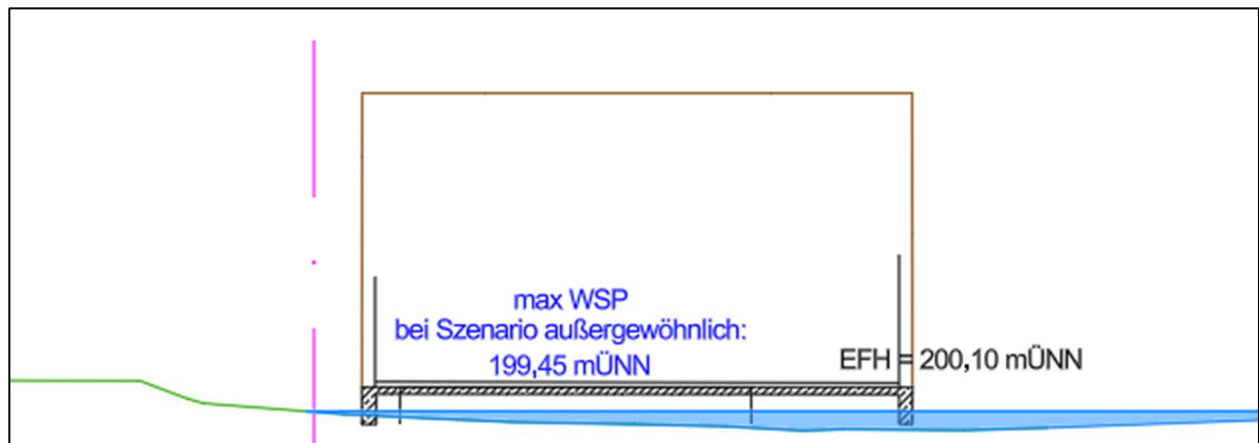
Querschnitt - geplante Bebauung und Überflutungsflächen Bereich Flurstück 474
